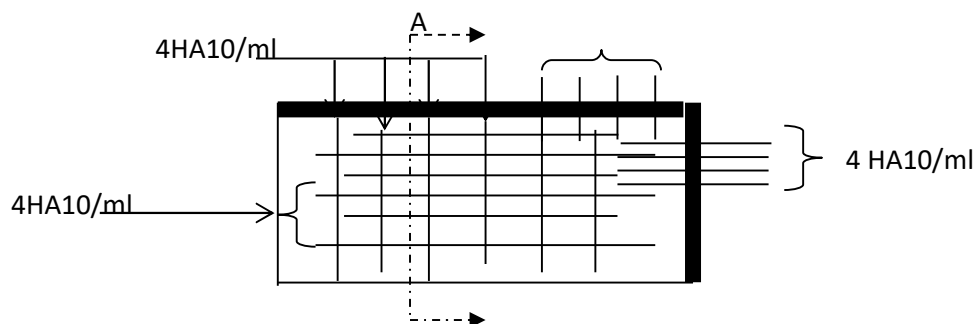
Schéma de ferrillage de balcon sur 2 appuis.
